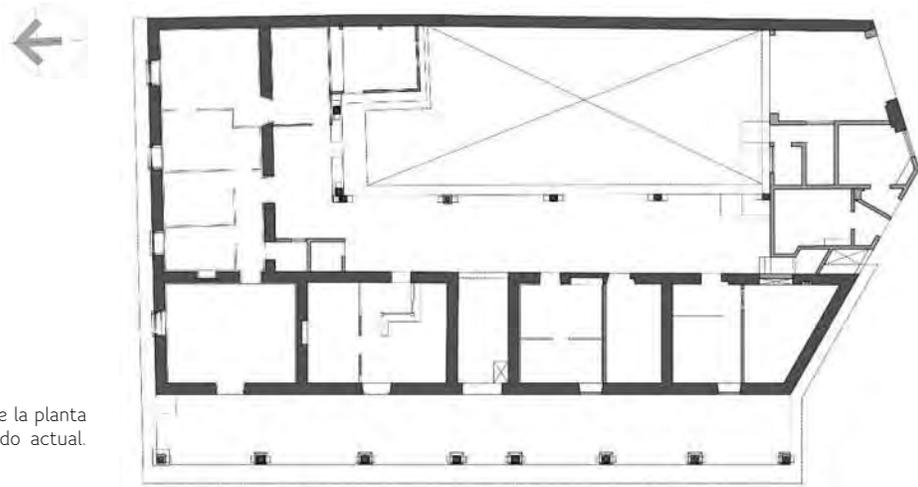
Croquis de la planta del inmueble en su estado actual. Elaboró: AMT.
